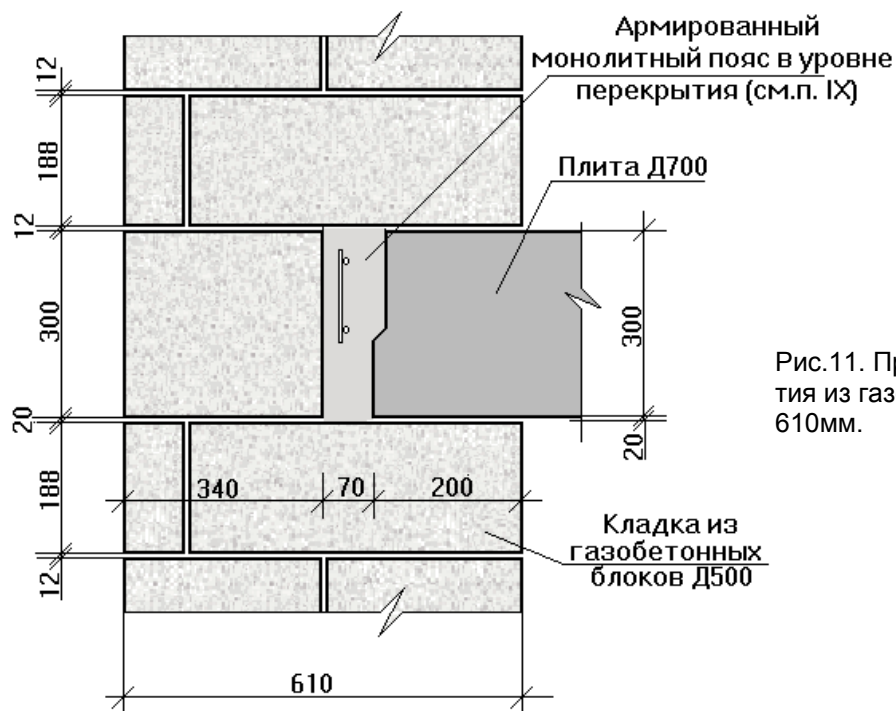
Пример опирания плиты перекрытия из газобетона на стену толщиной 610мм.
